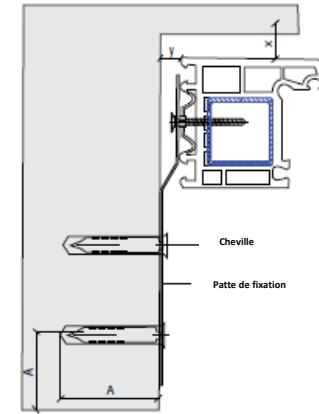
Installation du cadre de la fenêtre sur la cheville.
